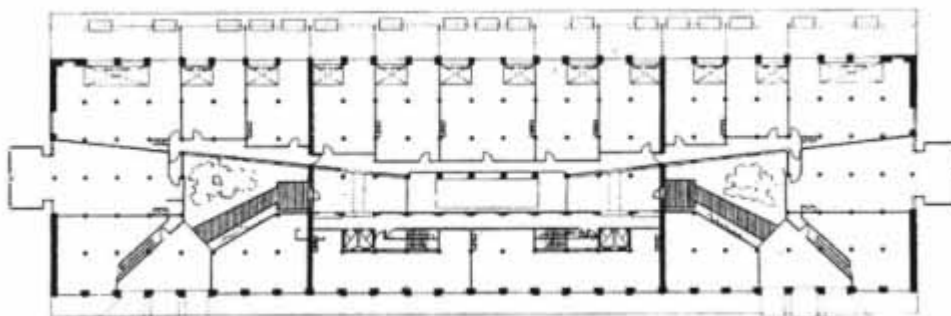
planta pavimento térreo do Galpão 5, destinado a uso comercial e de serviços. Fonte: Revista Arquis nº 1.
